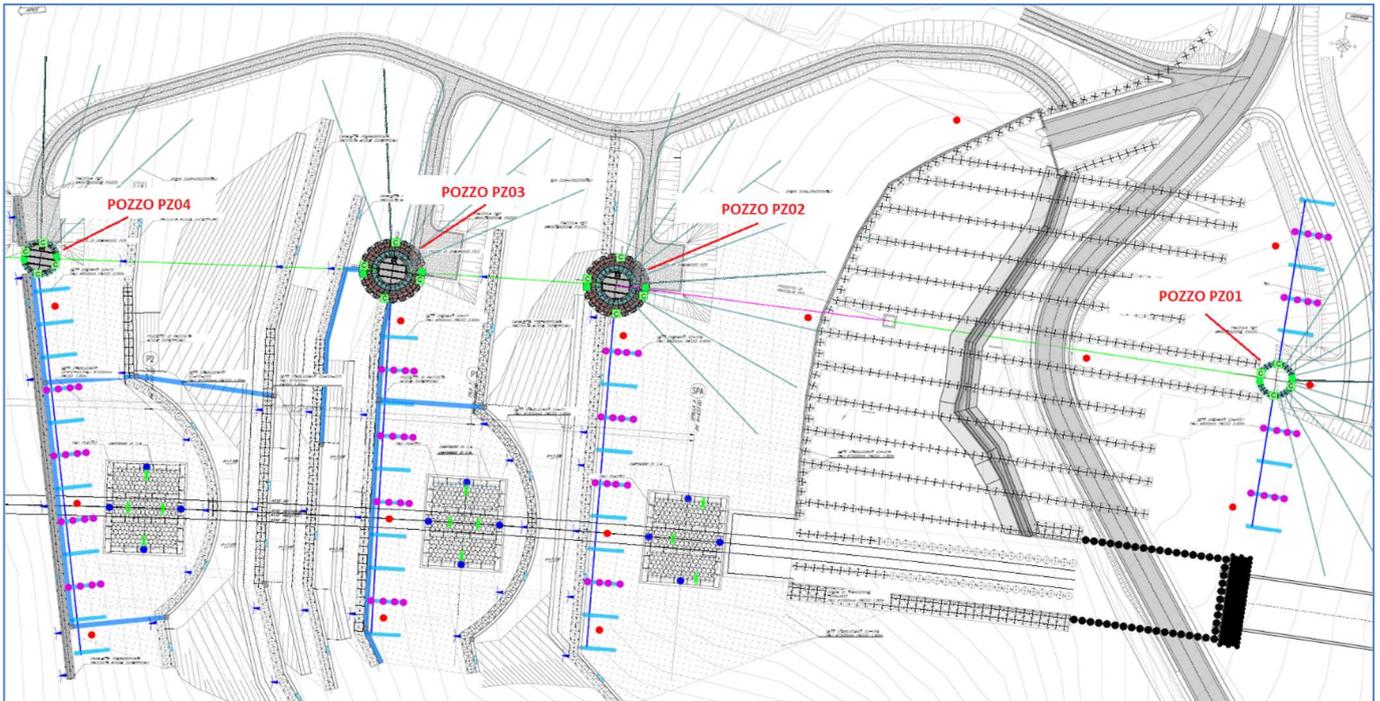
Stralcio Planimetrico con indicazione dei 4 Pozzi Drenanti PZ01, PZ02, PZ03 e PZ04
